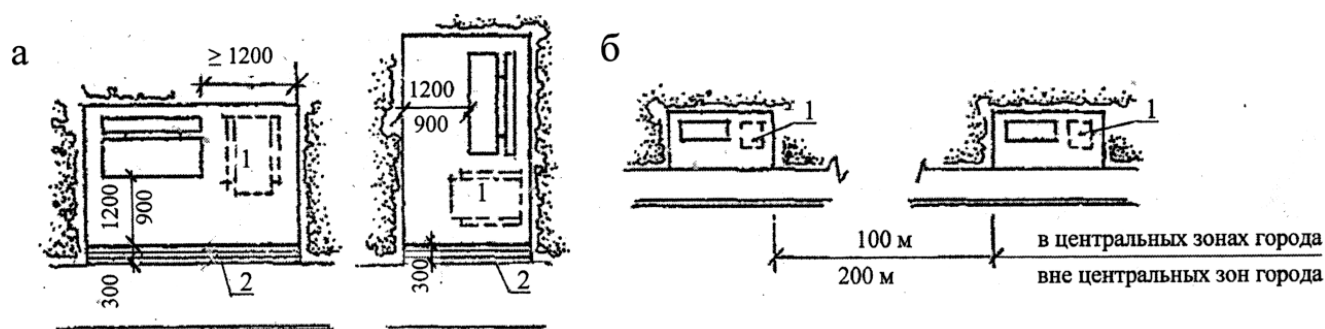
Площадки для отдыха: а – планы площадок; б – расстояния между площадками на пешеходных путях; 1 – место для кресла-коляски; 2 – направляющая линия из фактурной, контрастно окрашенной плитки
